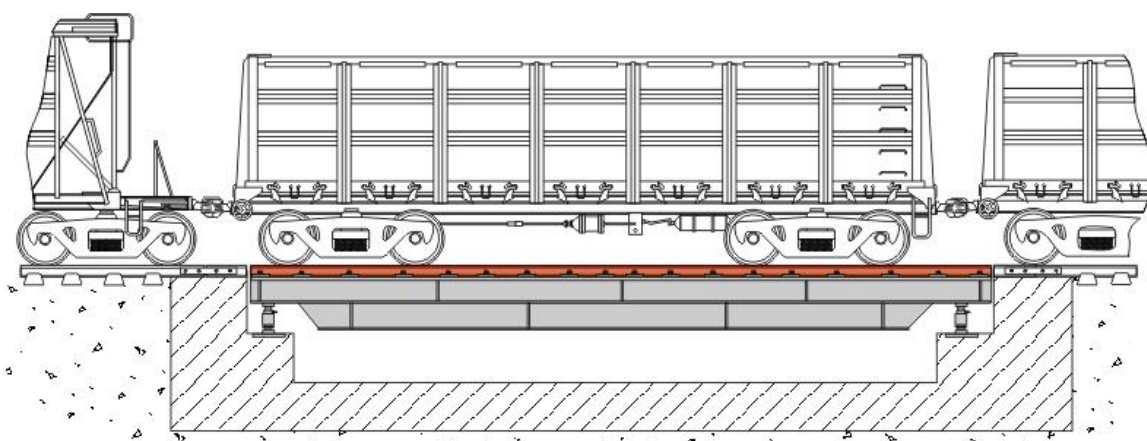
ГПУ весов с одной взвешивающей секцией (грузоприемной платформой), установленное на железобетонный фундамент
